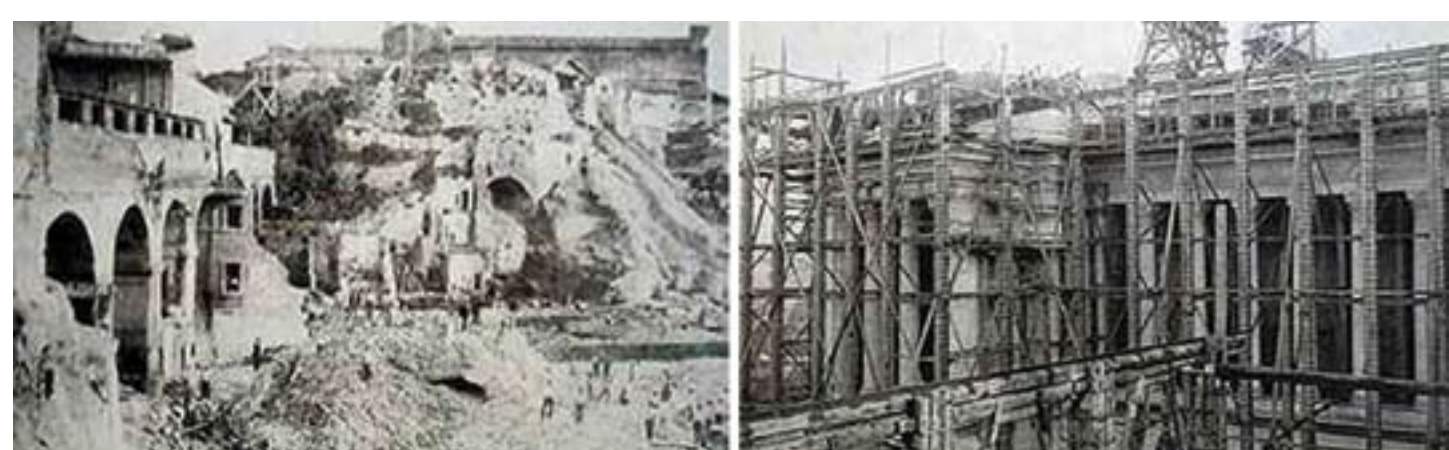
Esecuzione degli scavi preparatori per la costruzione del progetto di Sacconi e realizzazione delle strutture in elevazione
